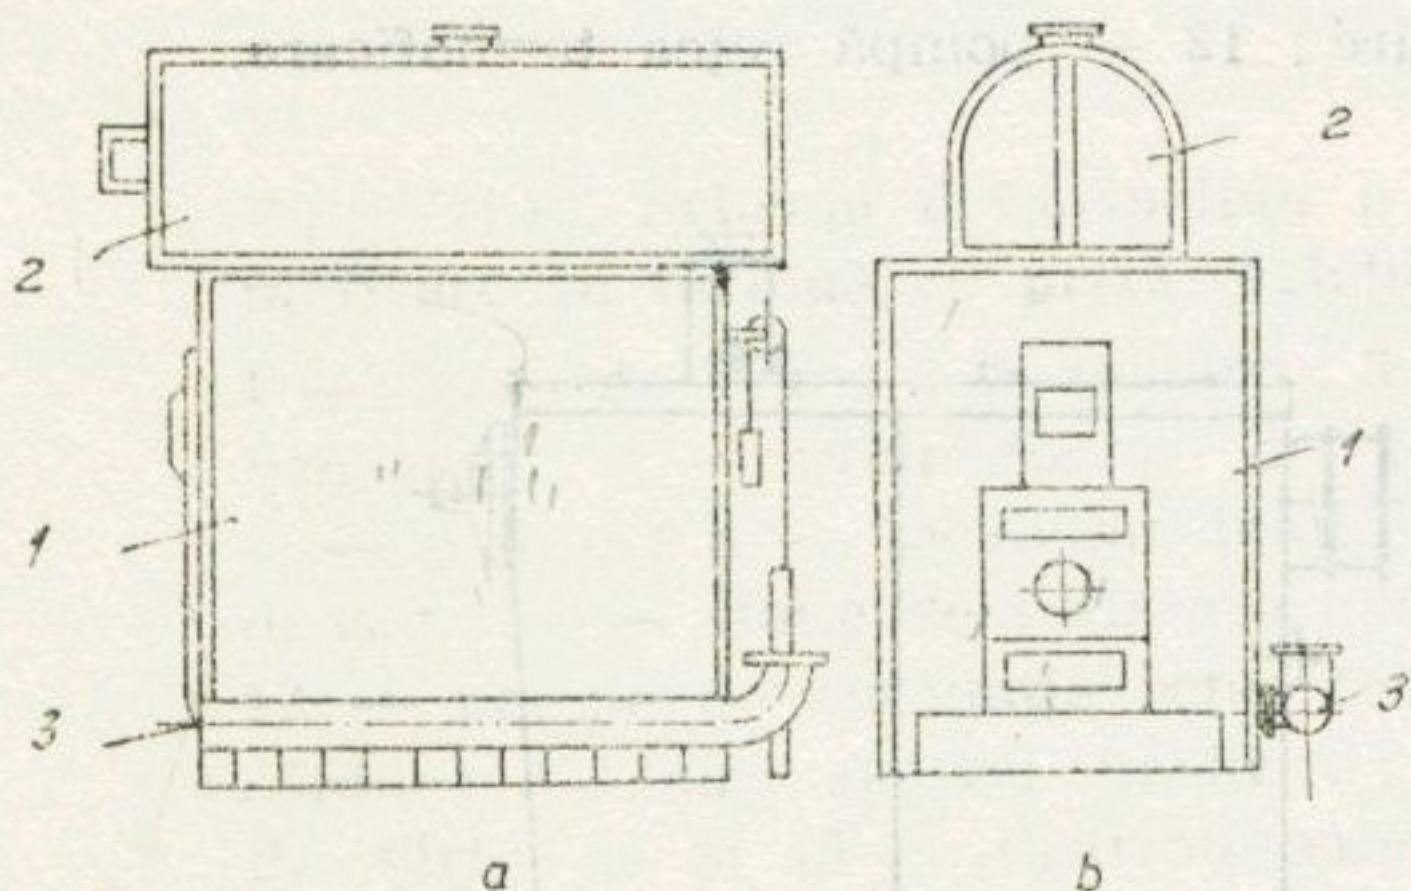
Cazan din elemente secționare de oțel, tip „Metalica“, pentru apă caldă :
